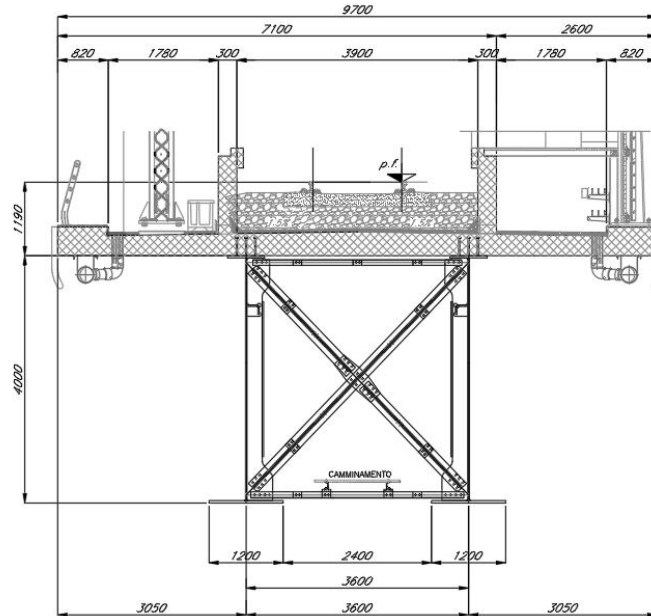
Sezione trasversale campate in acciaio-clt L=50 m
